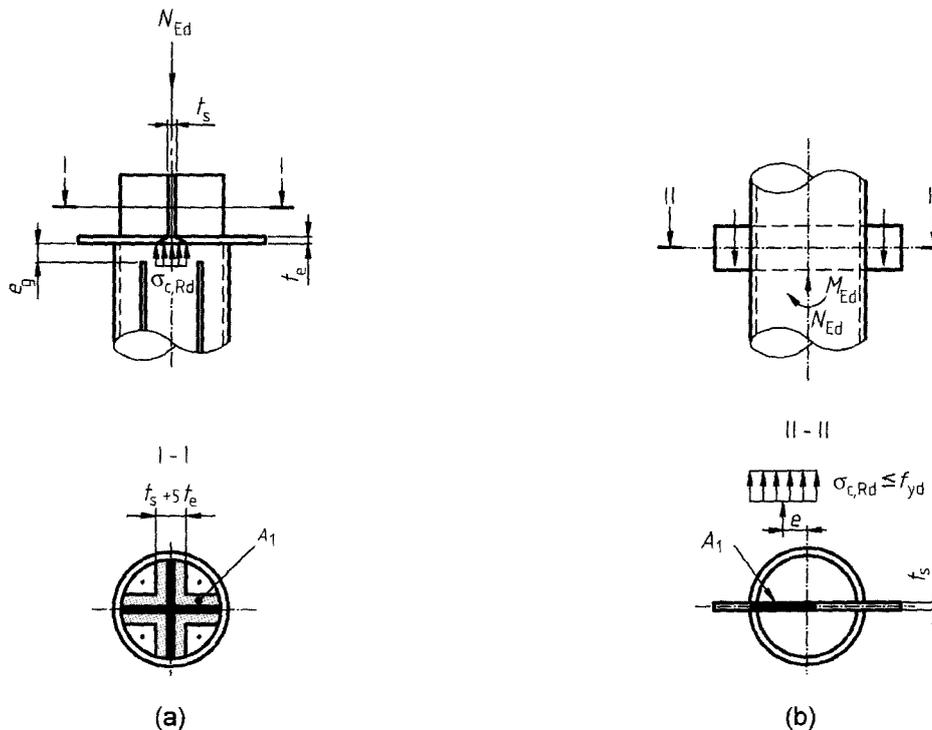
Teilflächenpressung bei ausbetonierten Hohlprofilen
